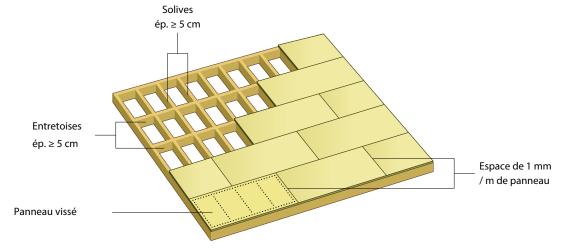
Exemple de contreventement des planchers par des plaques à base de bois
